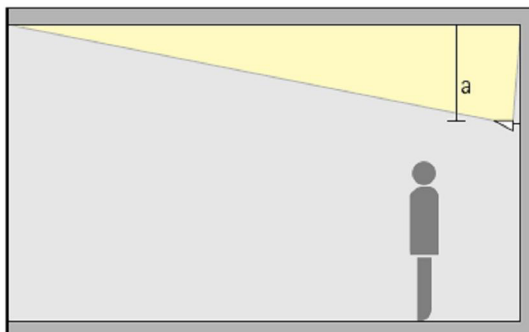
L'altezza di installazione da terra dei washer per soffitto deve risultare sopra la linea degli occhi. La distanza a degli apparecchi dal soffitto dipende dall'omogeneità con cui si vuole illuminare il soffitto stesso e comunque generalmente si pone $a > 0,8$ metri (fonte ERCO)
